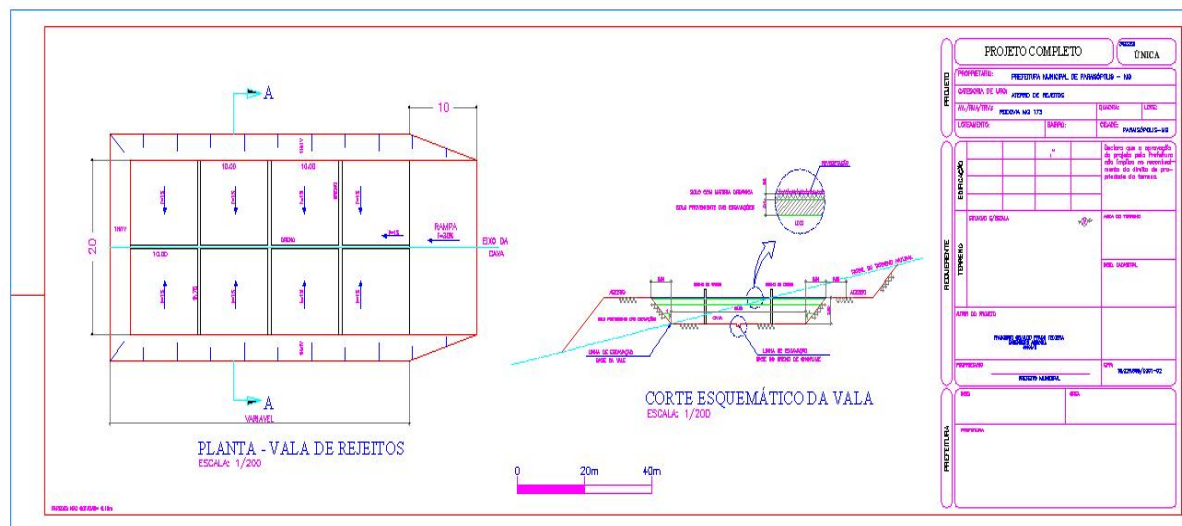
Planta das trincheiras para o AS de Paraisópolis-MG
